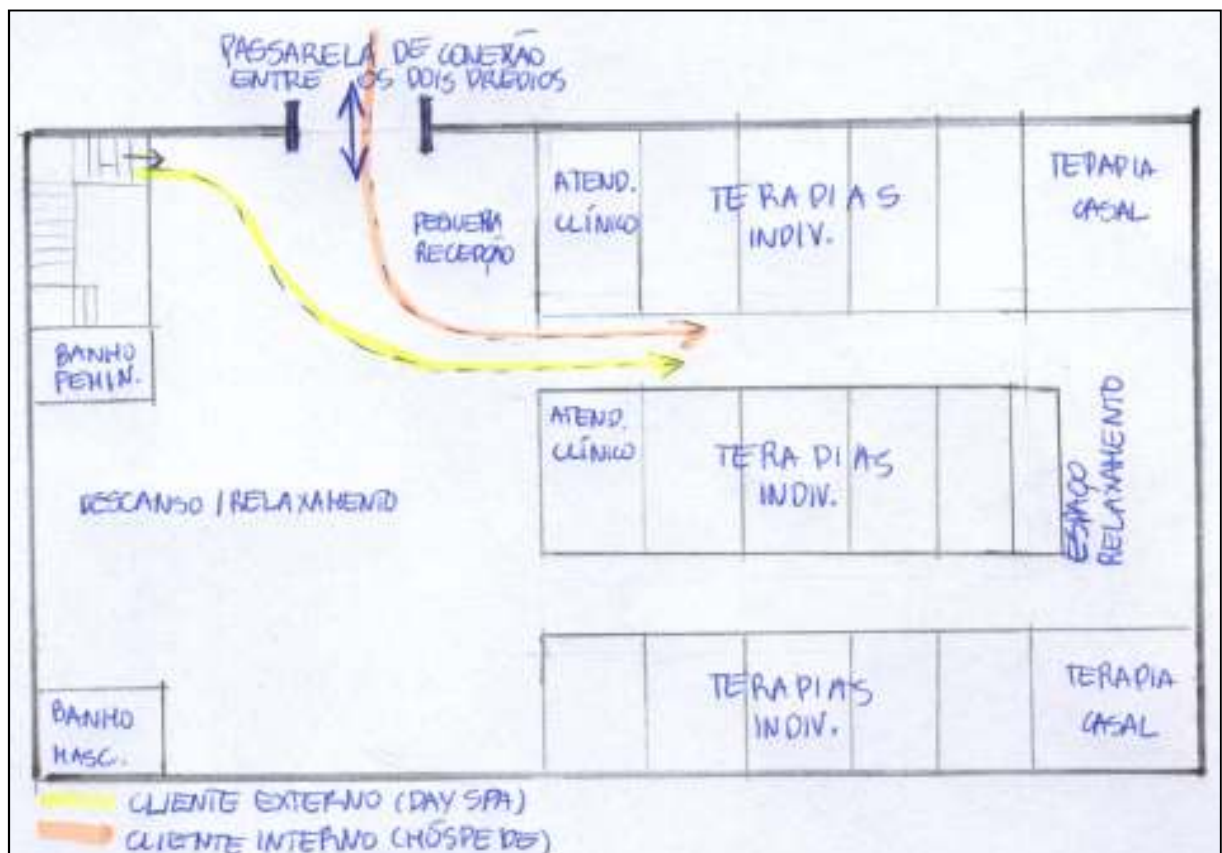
Croqui esquemático da planta baixa do térreo do Day Spa – estação das Águas.
